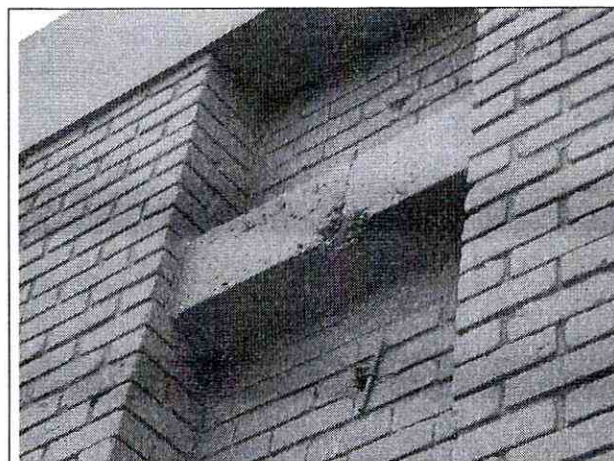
Detalle de la viga en concreto ubicada cerca de la corona del muro de cerramiento.
